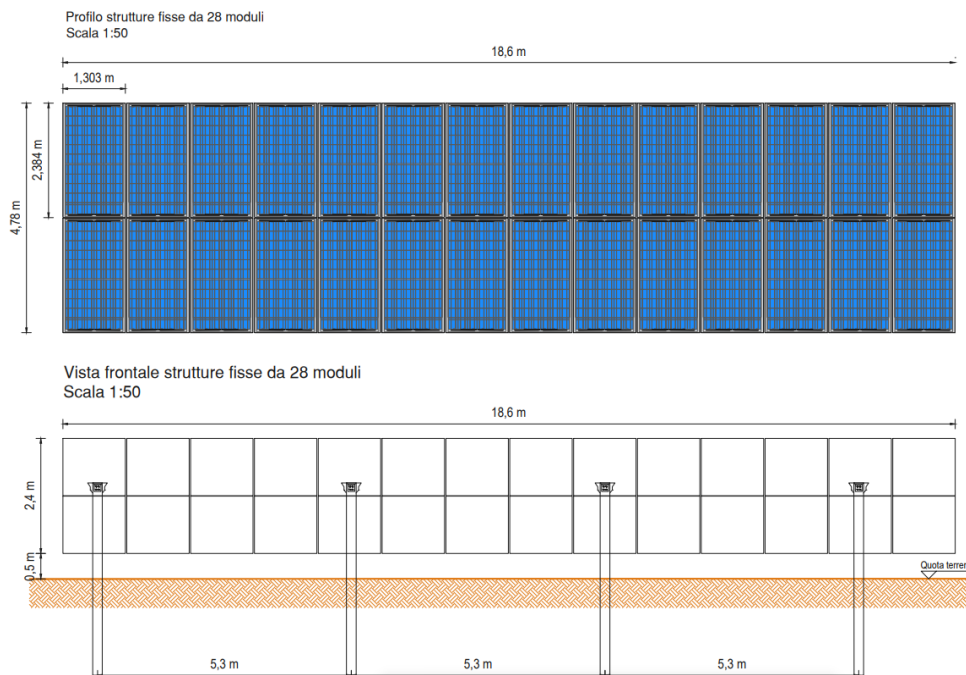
Pianta e prospetto strutture fisse di sostegno moduli FV
